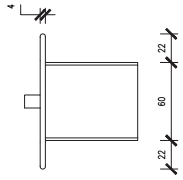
RUANG TERPILIH 1
